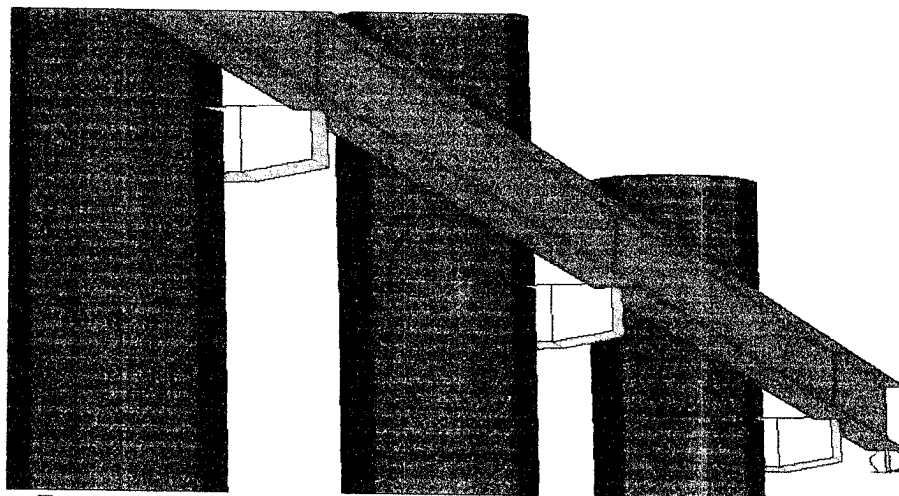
, Detalle modelado de viga del puente grúa apoyada sobre ménsulas.
